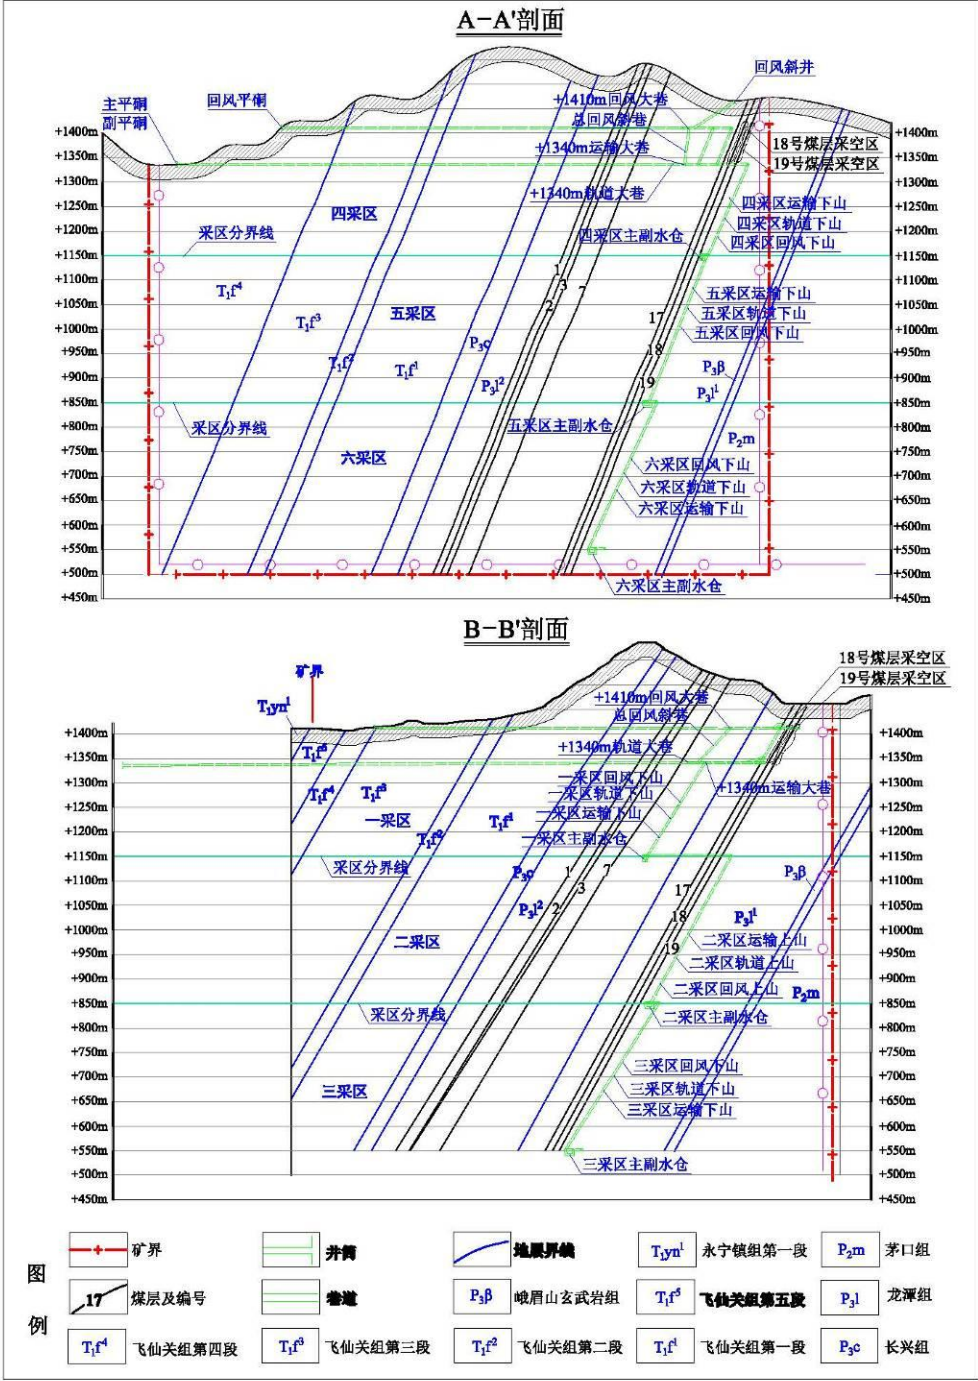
青菜塘煤矿（兼井重组）全井田开拓系统剖面图
